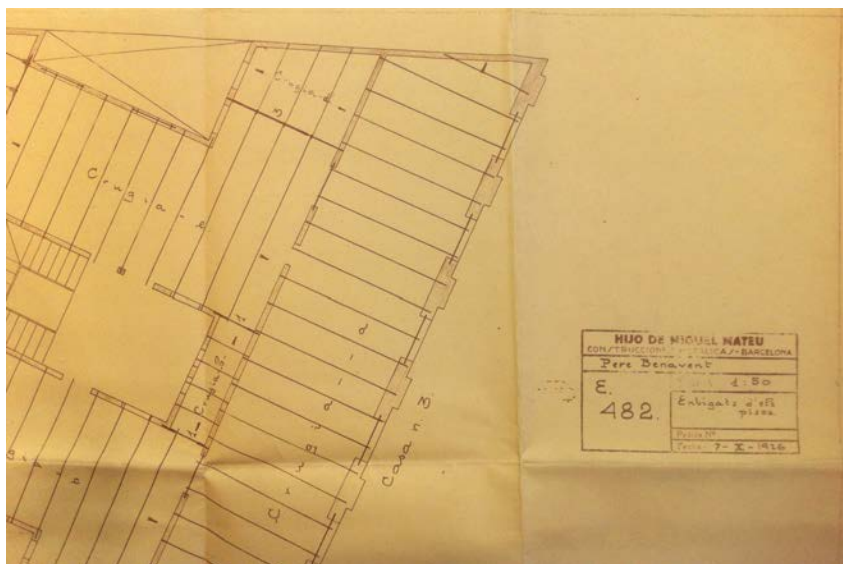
Plànol d'estructures de planta pis (casa Manuel Bargañó, Pere Benavent, 1926). Font: AHCOAC H109B/1/3.
